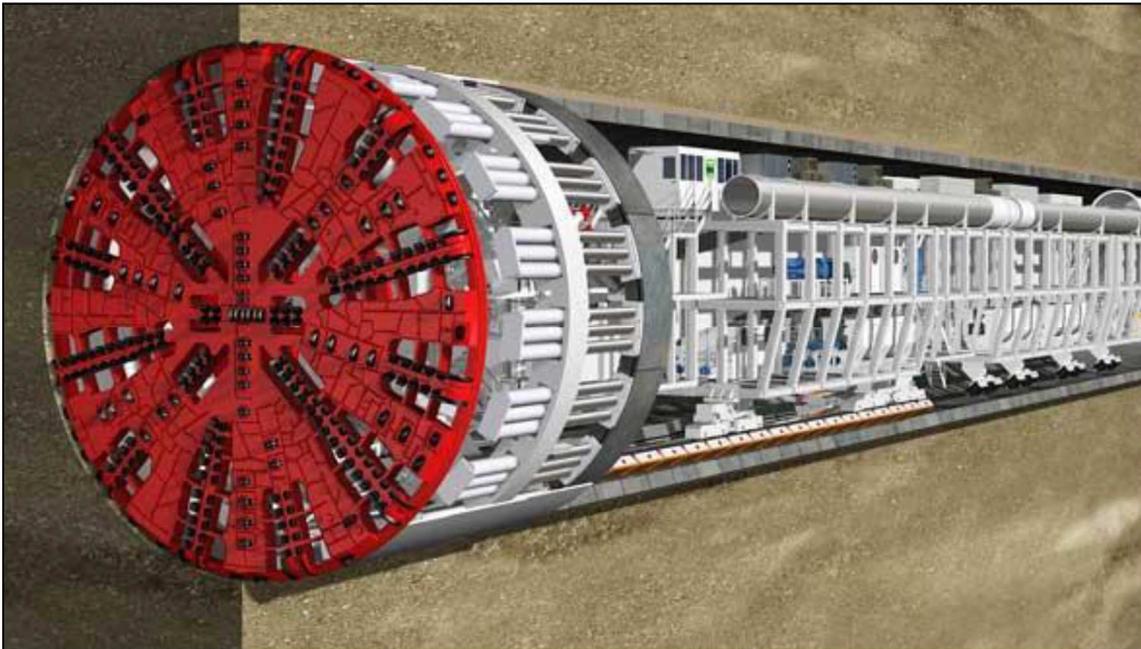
Schema di impegno della TBM (Tunnel Boring Machine)
